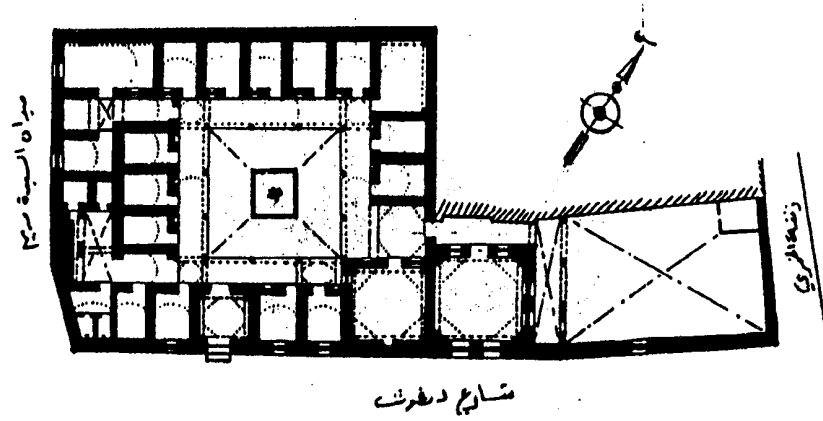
مسقط أفقي لمدرسة السلطان سليم الثاني ضمن مجمعه (كليته)
